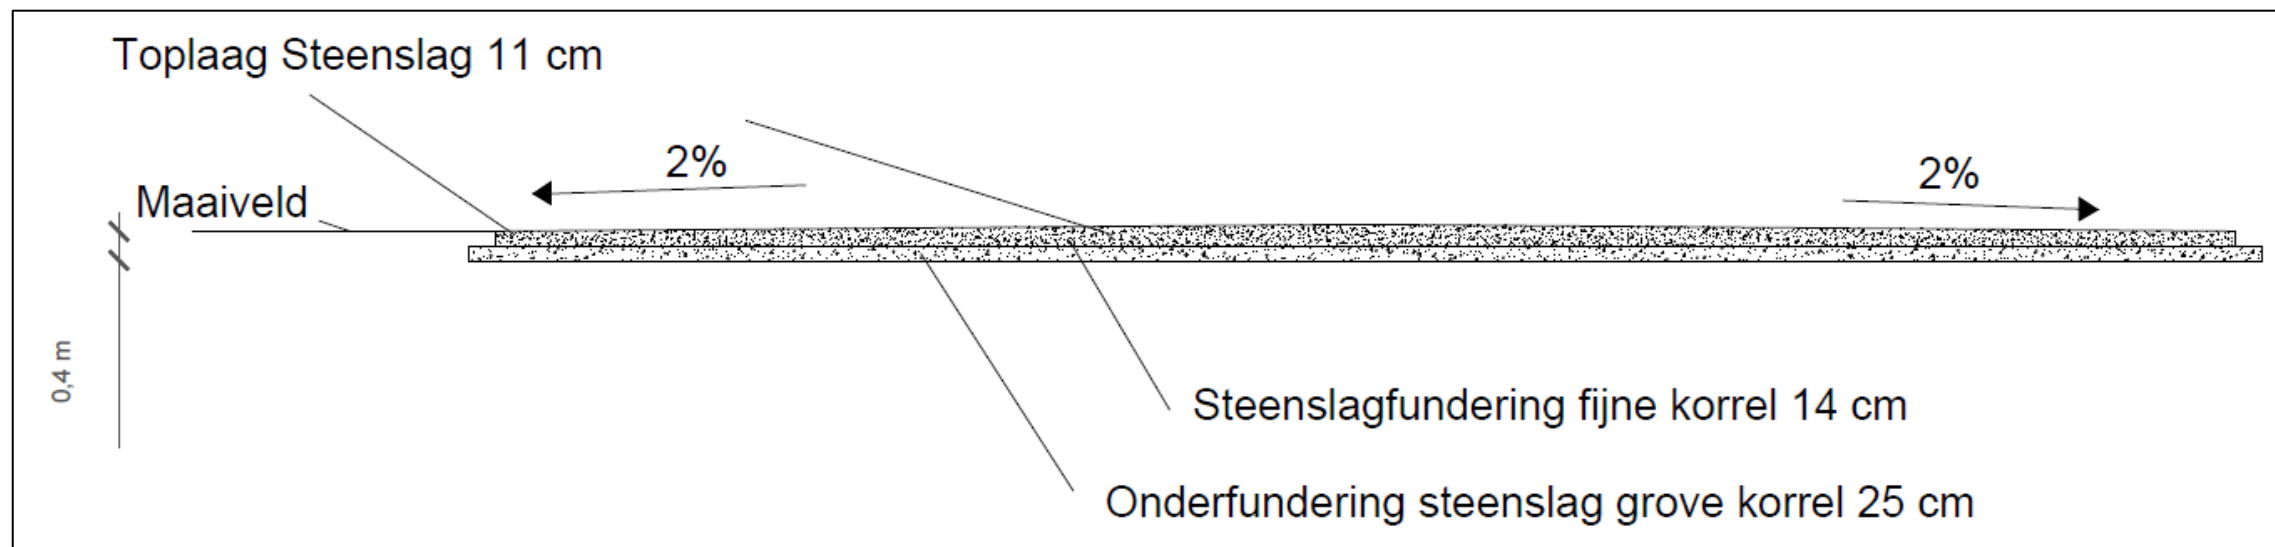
Plan voor WT2 (bron: opdrachtgever)
